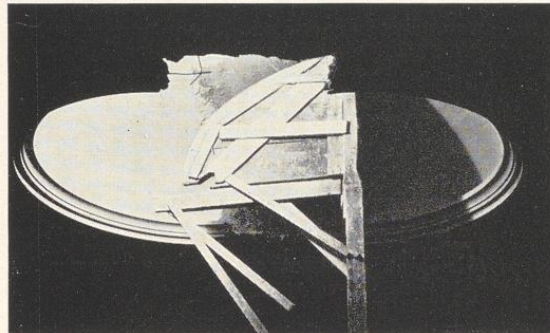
Kleines Muldengewölbe für indirekte Beleuchtung auf einer Rabitzdecke mit dem drehbaren Flügel ausgezogen
